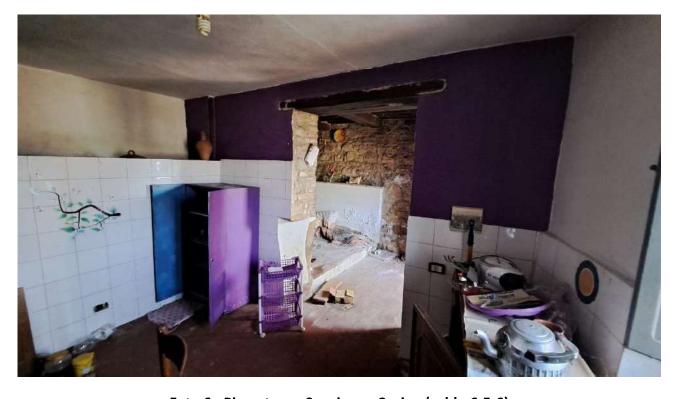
Piano terra, Soggiorno-Cucina (subb. 6-5-6)
